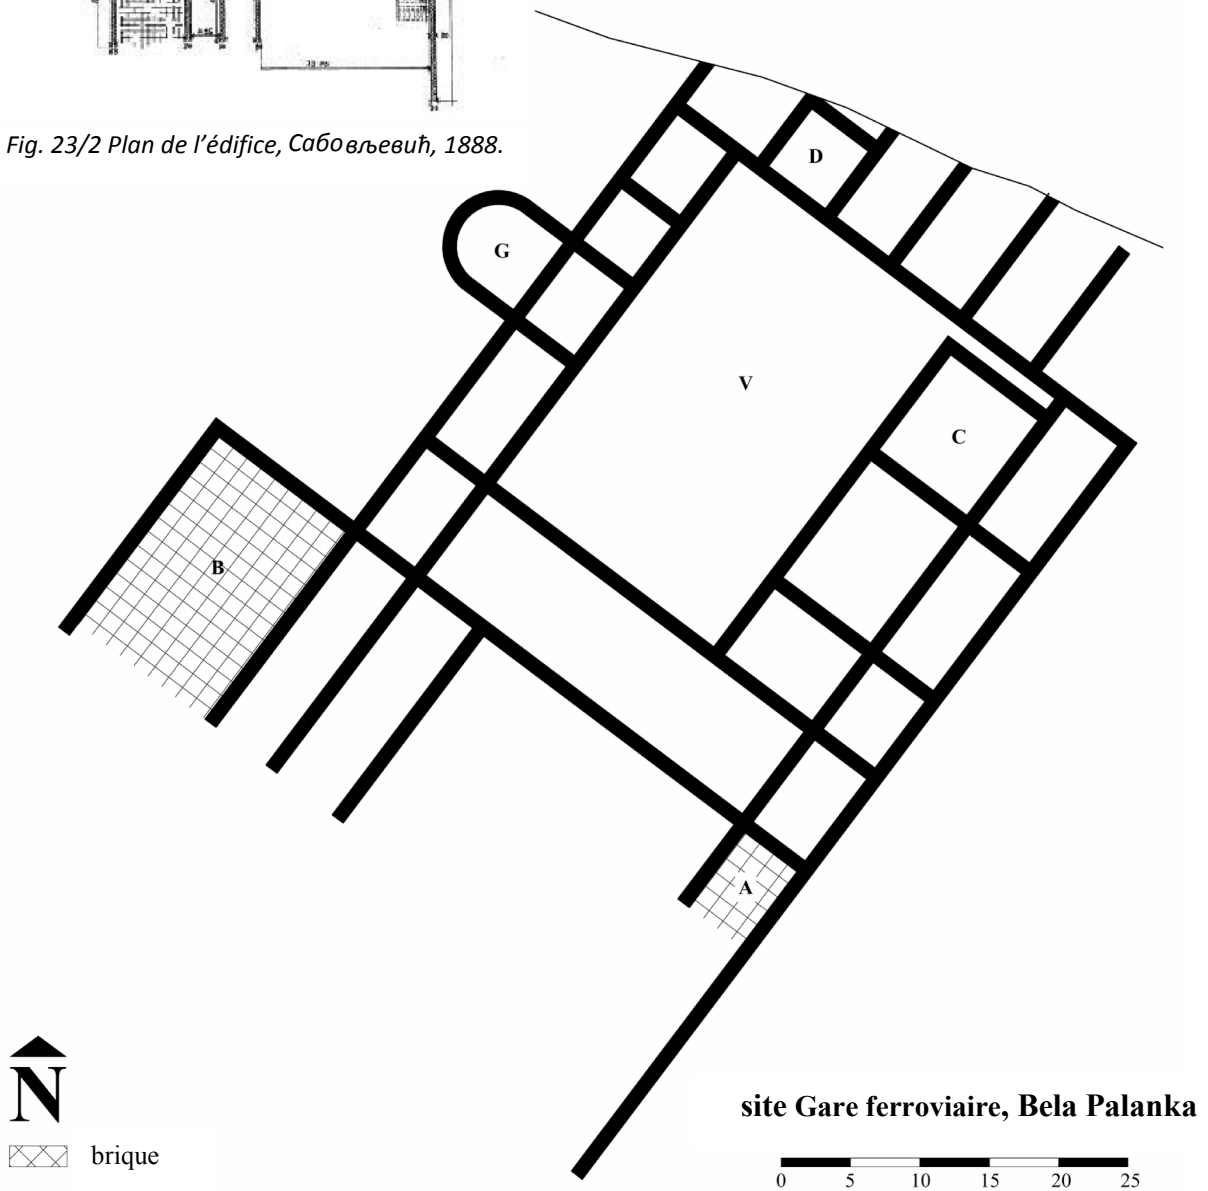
/3, Plan de l'édifice, site de la Gare ferroviaire, Bela Palanka, A. M. d'après : Сабовљевић, 1888
